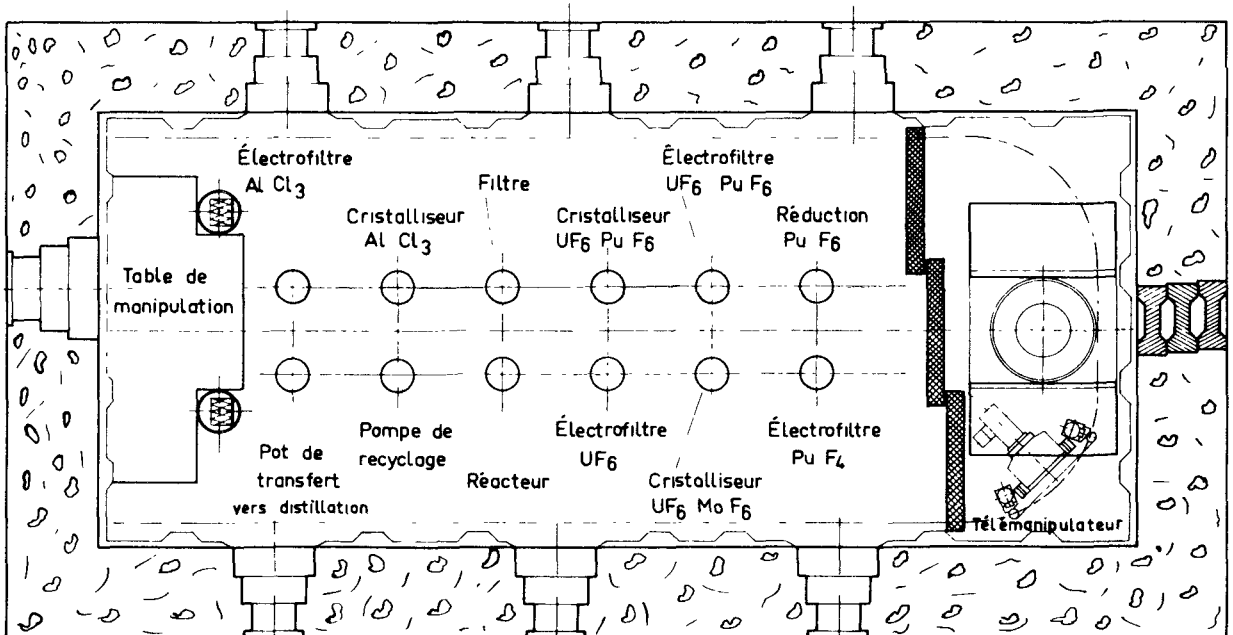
Installation pilote sur matériaux irradiés; plan de la cellule principale
